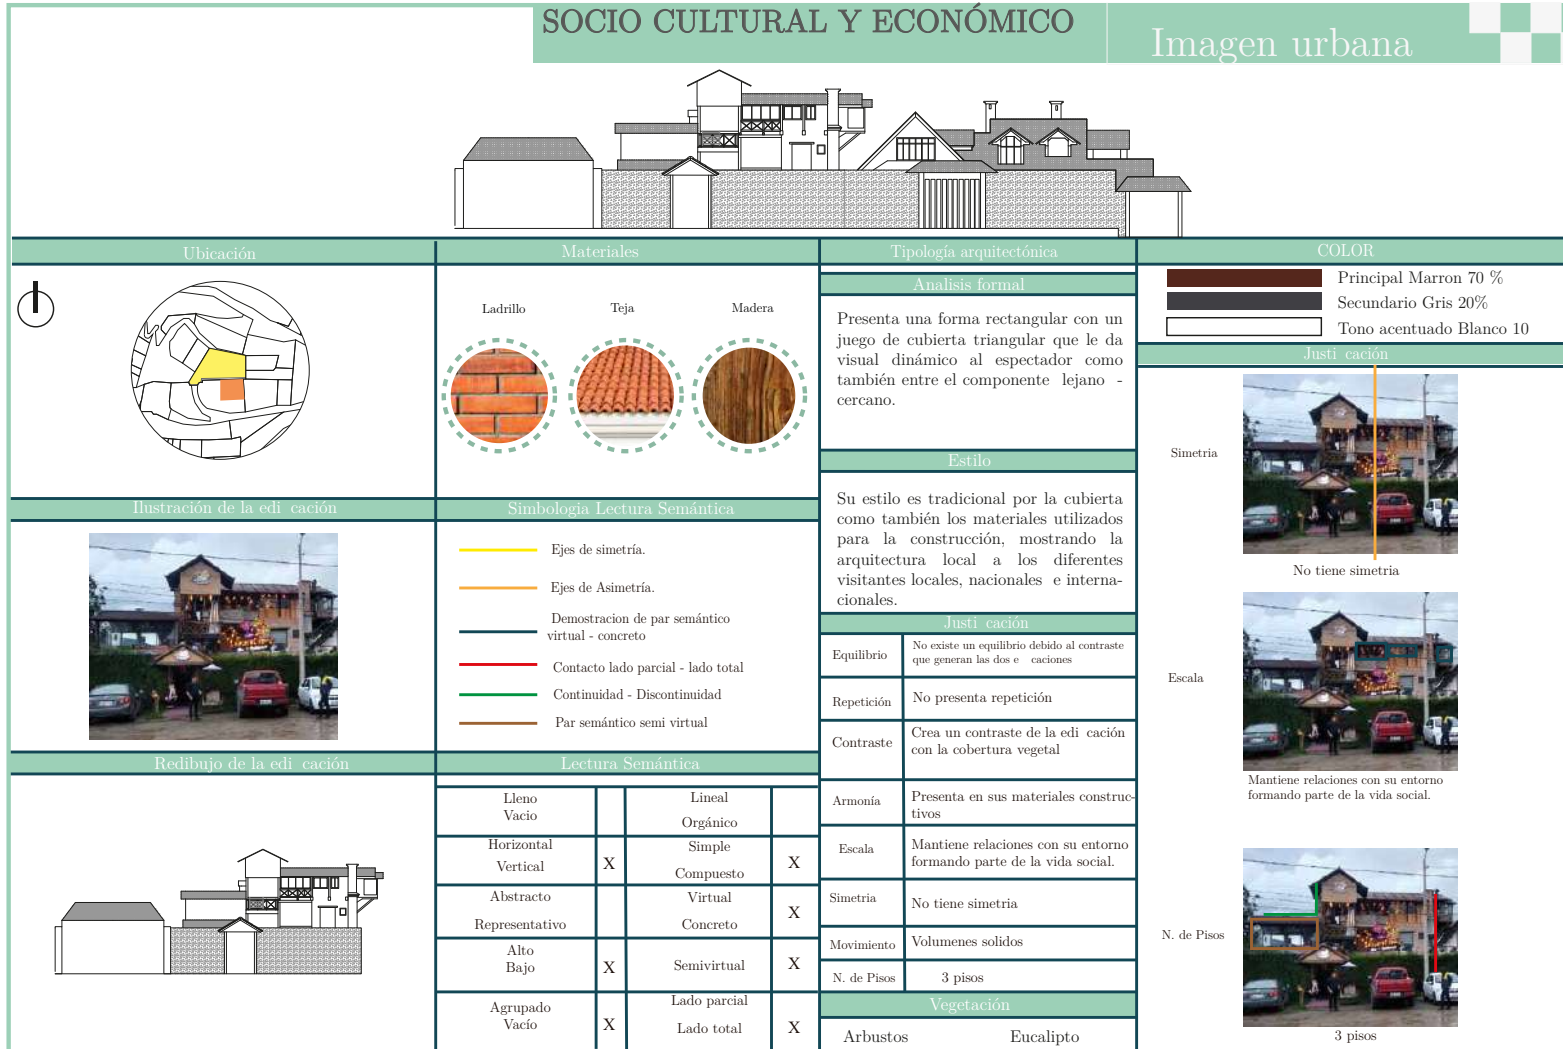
Levantamiento de la imagen urbana sur por edificación. Fuente y elaboración: Propia.
